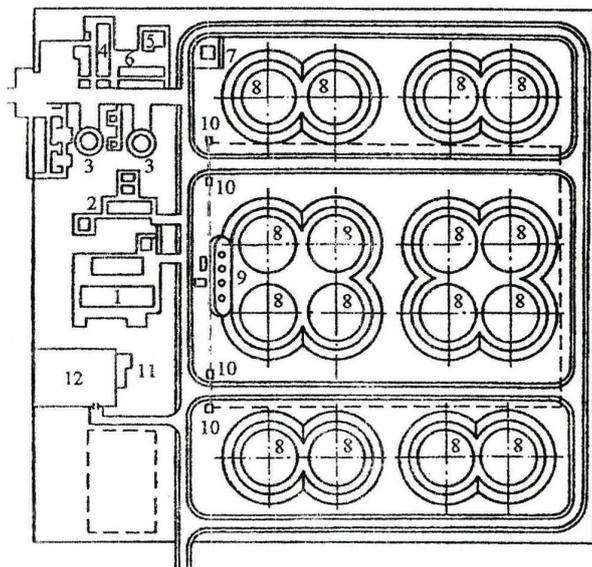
Генеральный план головной нефтеперекачивающей станции:
